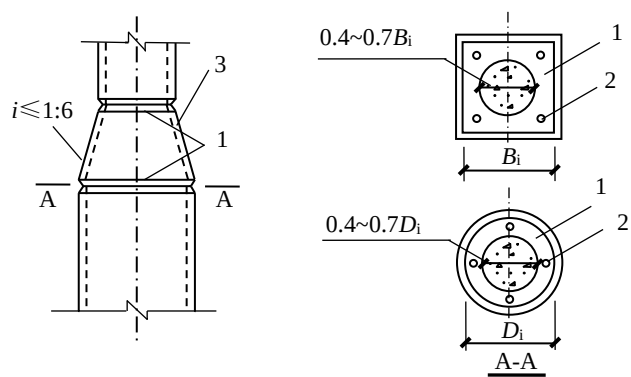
钢管再生混凝土变截面柱连接构造示意图
